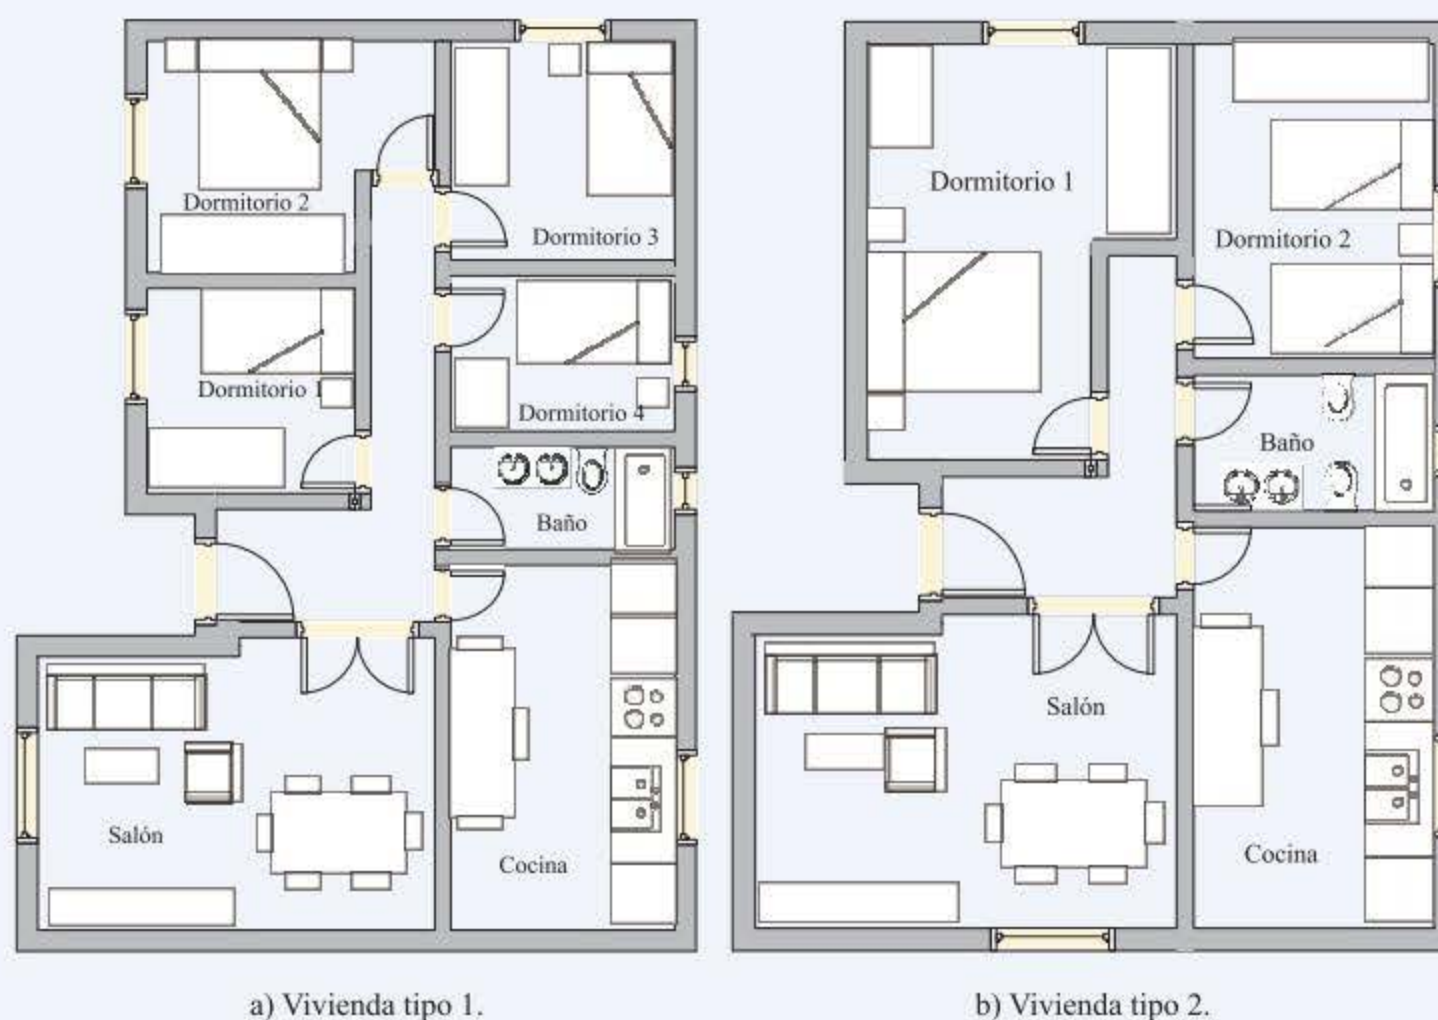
Planta tipo de las viviendas del edificio bajo estudio.
